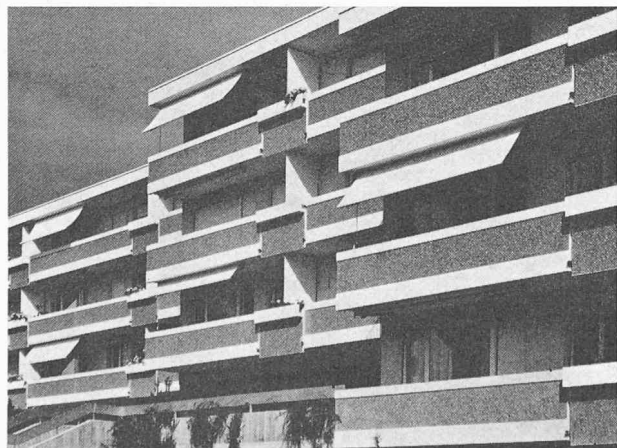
Bâtiment locatif à Bienne/BE. Parapets de balcon en béton lavé et béton apparent combinés, éléments de bordures de toit en béton apparent.
